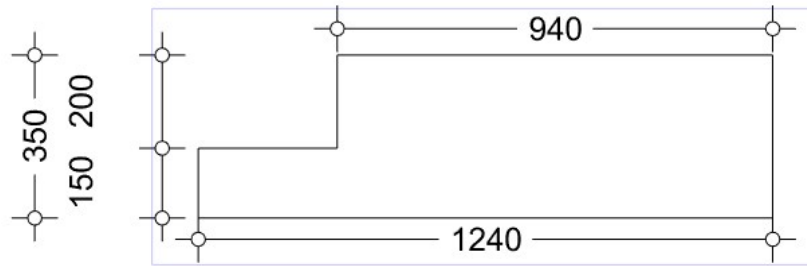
Tipikal Model *Redesign Half Slab* Tipe – 2A
